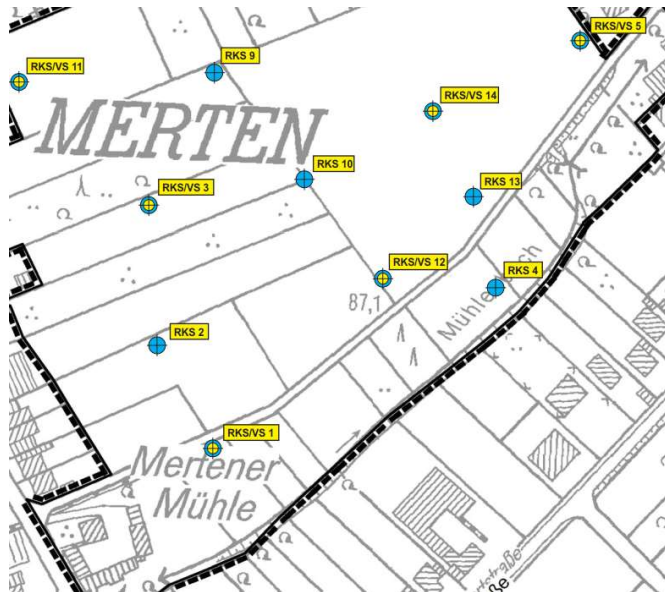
Ausschnitt aus dem Lageplan der Rammkernsondierungen [8]
